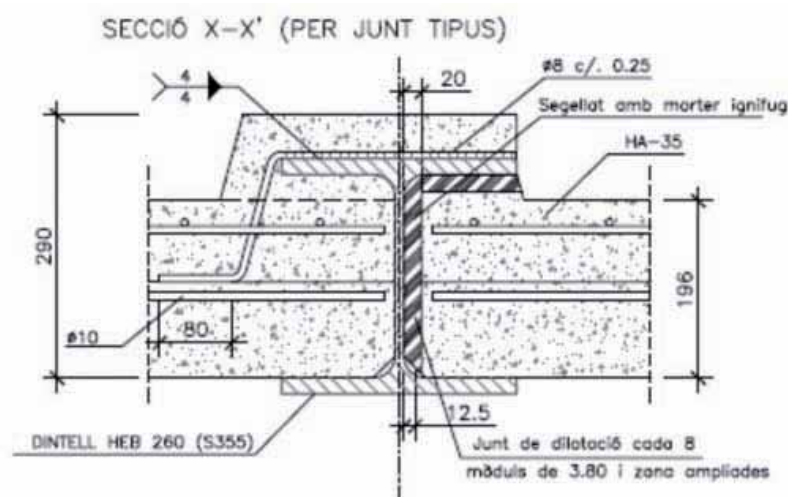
Detalle de la junta de dilatación entre dinteles del forjado mixto ligero.
